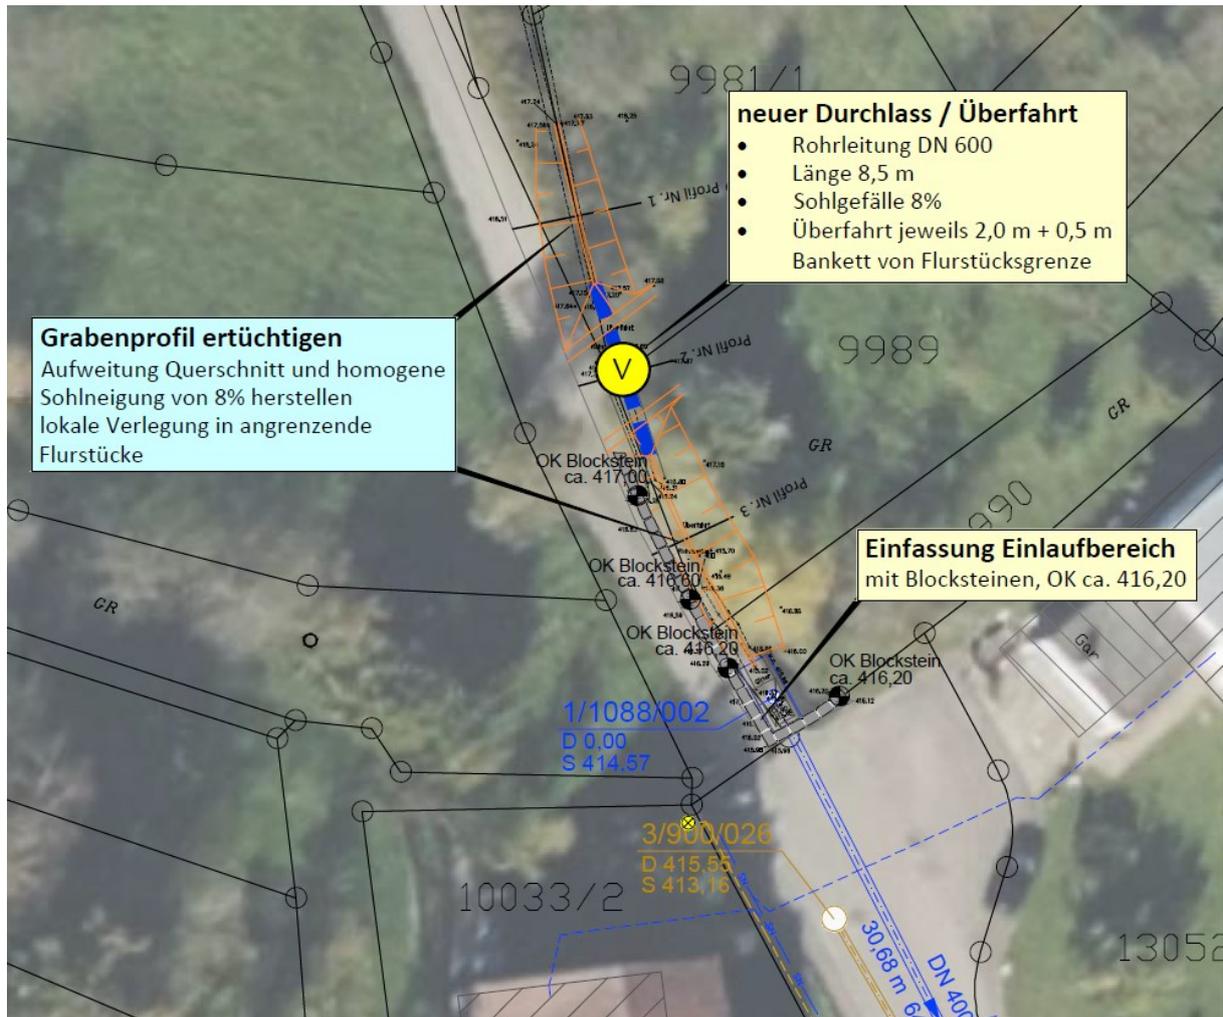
Ausschnitt Lageplan Maßnahmen am Einlauf der Lochbachverdolung
